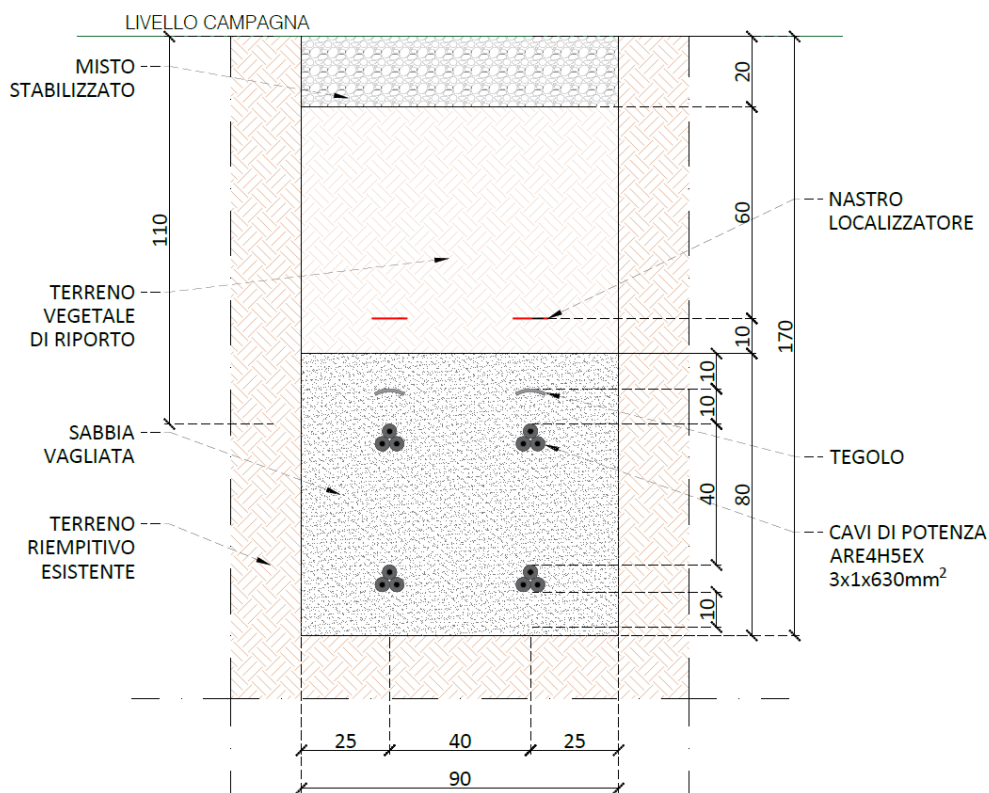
Sezione di scavo cavidotto di collegamento 30 kV 3x4x630 mm²
